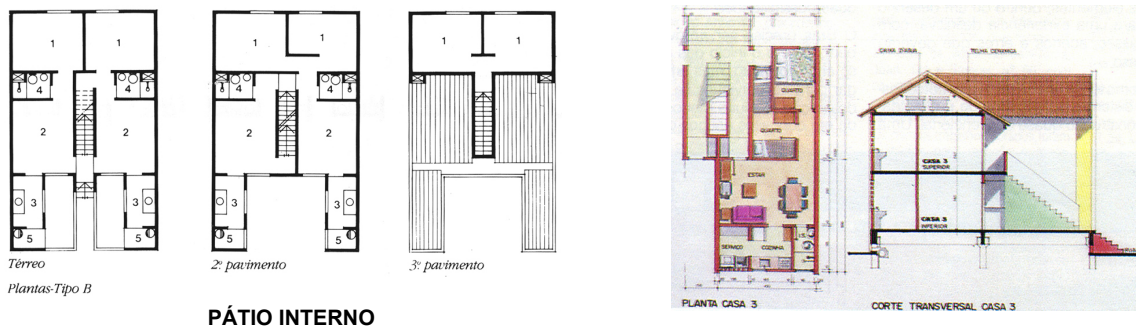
Planta das UHs do Projeto Heliópolis I (VB-07); Planta e corte de UH do Projeto Área no Brás (M-06).
